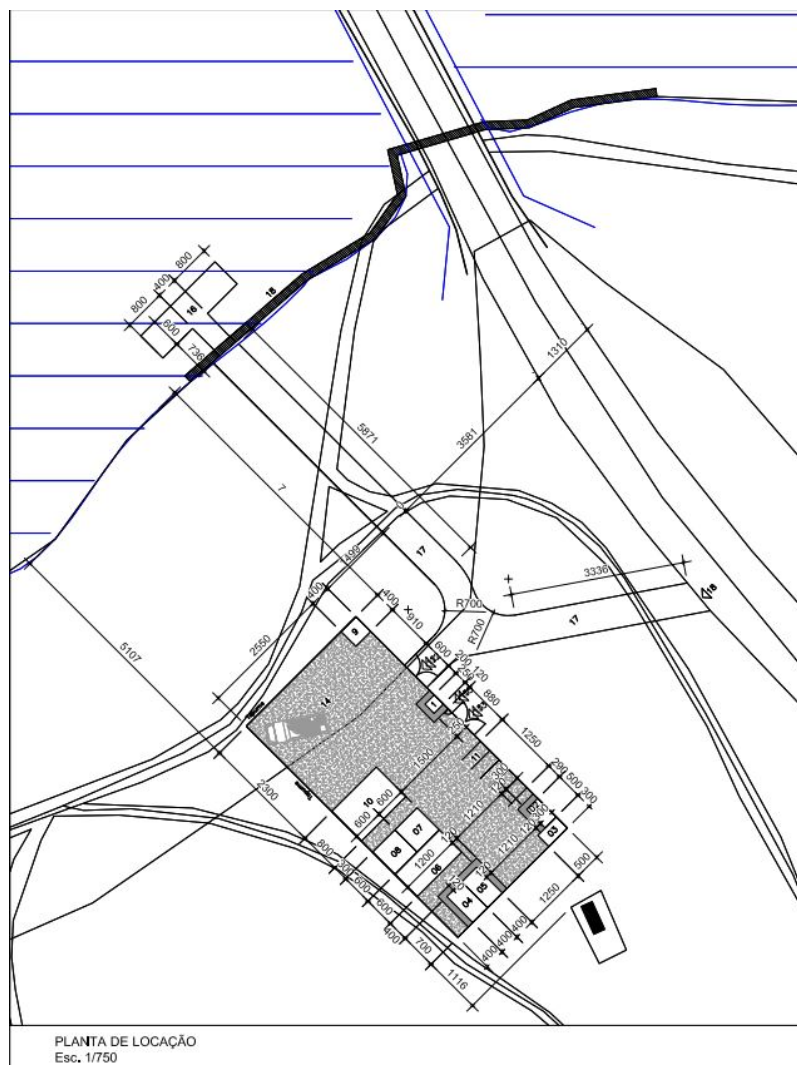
Planta do Canteiro de obras, pier e acessos. Fonte: NOVACAP
